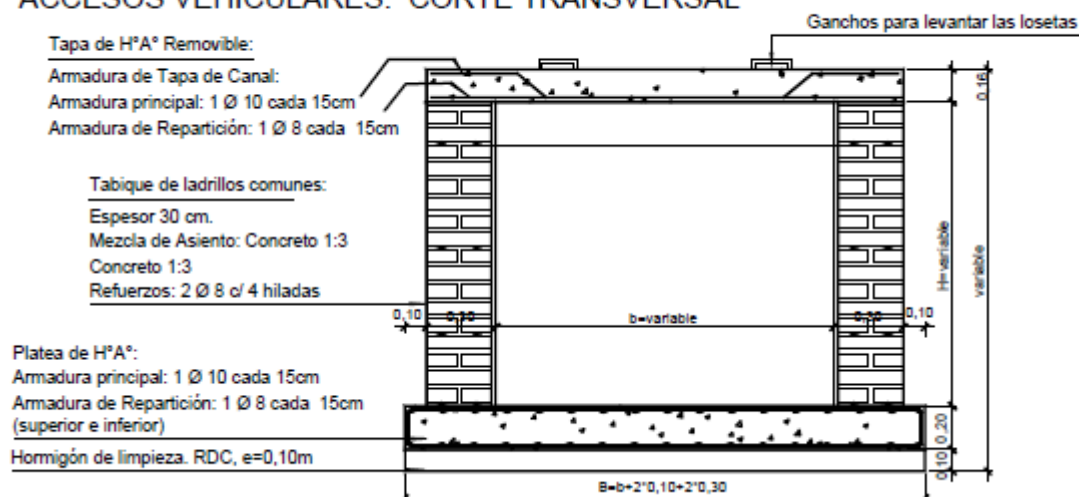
Corte transversal canal revestido de mampostería con tapa (Fuente: elaboración propia, 2025)
